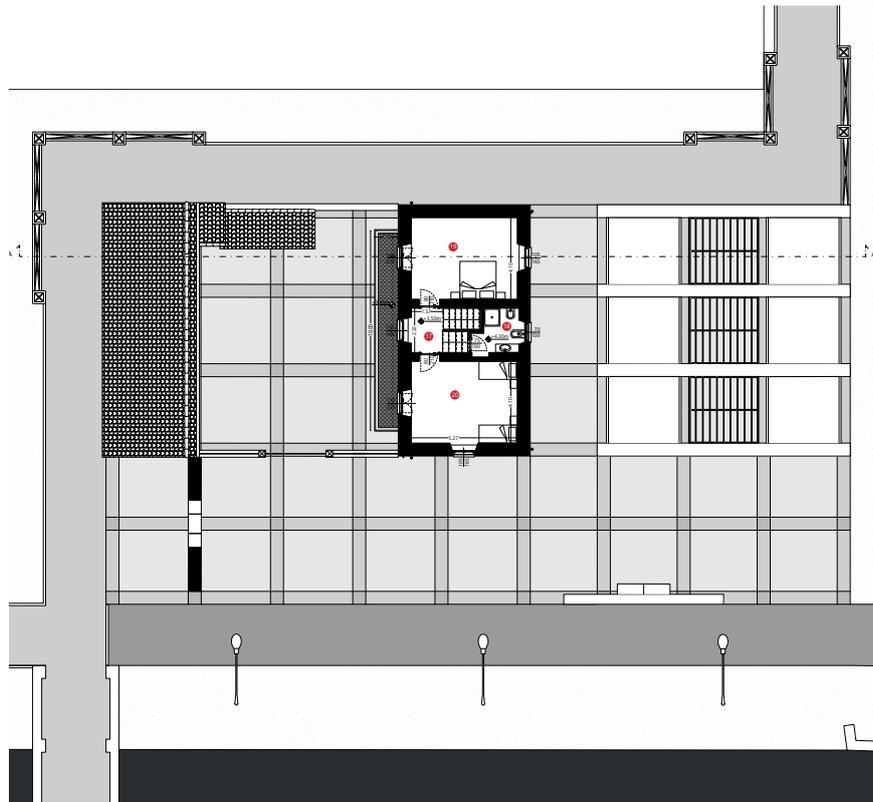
Pianta di progetto del piano primo. Estratto della tavola 06_Piante di progetto.
